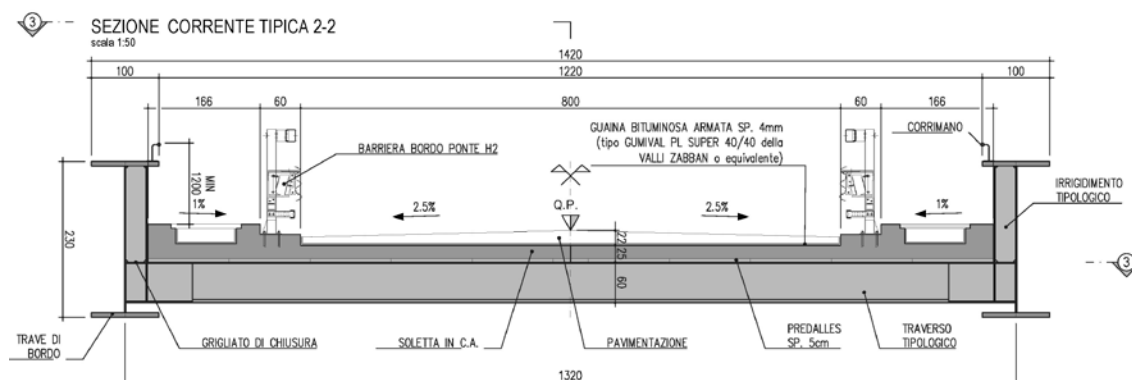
Ponte sul canale Marzenego – Sezione trasversale
